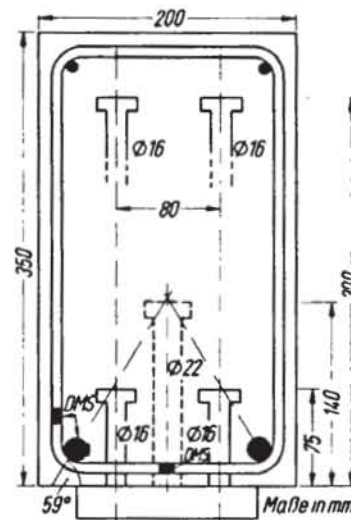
Querschnitt der Versuchsbalken und Lage der Kopfbolzen
